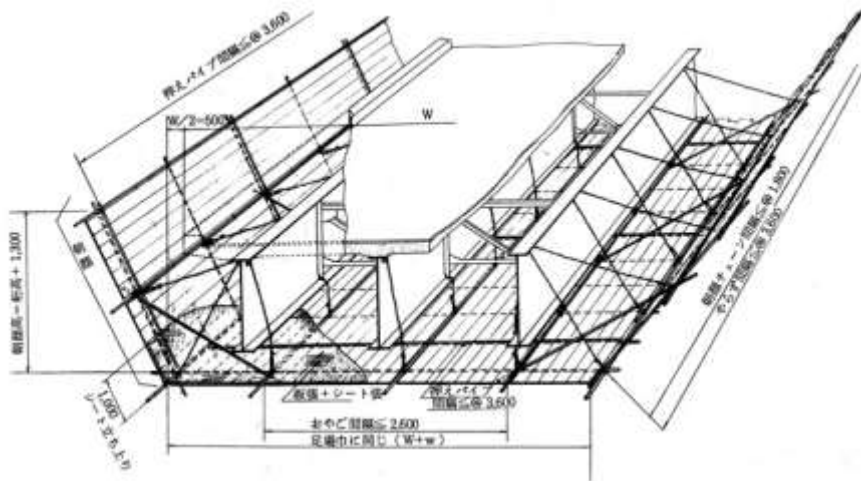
パイプ吊り足場(例:プレートガーダー橋)
